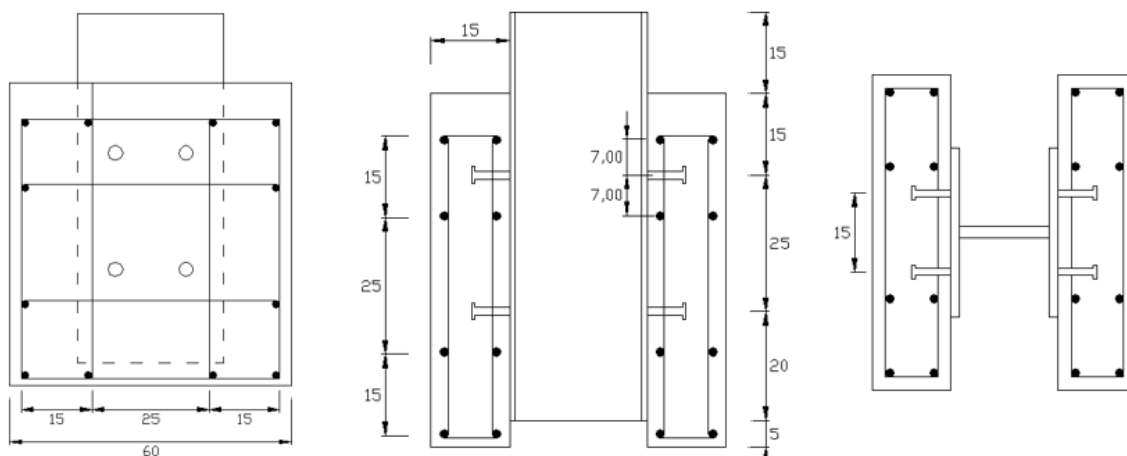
Modelo adotado para o conector do tipo *stud bolt* estudado por Cavalcante (2010)
